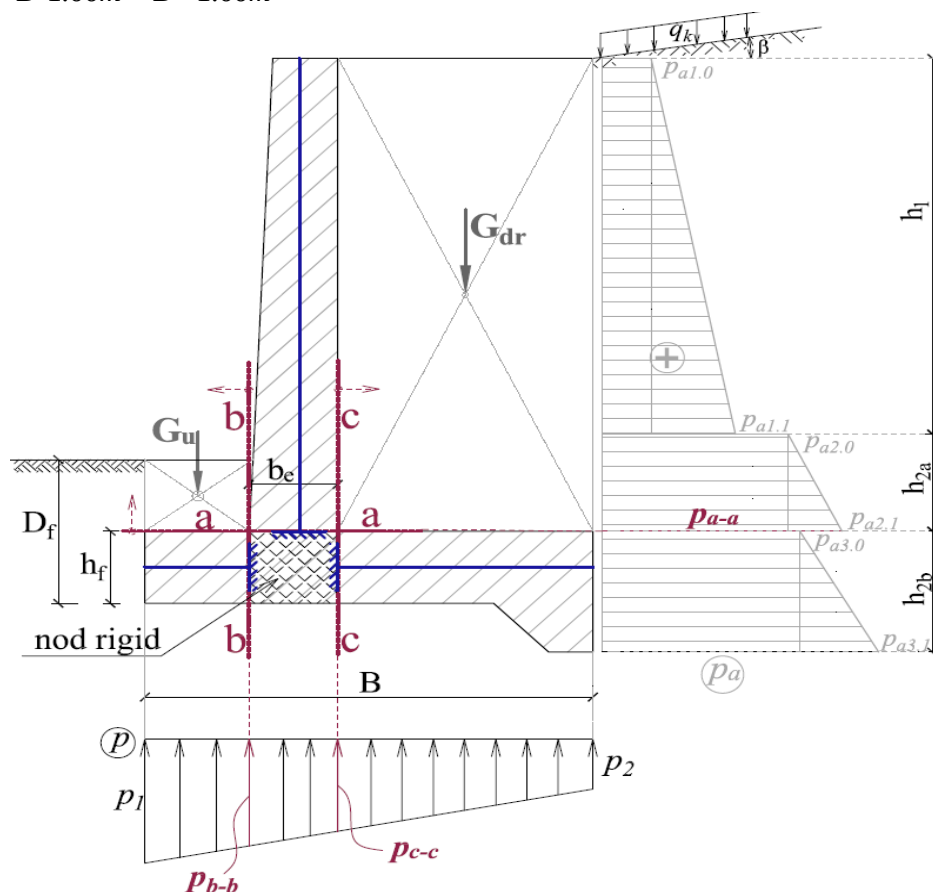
Secțiuni periculoase zid de sprijin de beton armat (schema consolelor echivalente).
